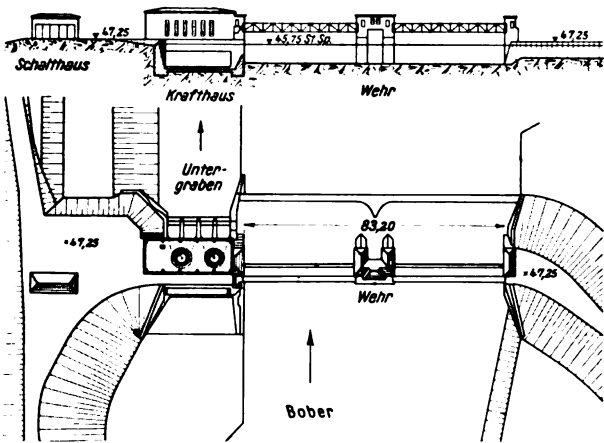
Boberkraftwerk: Wehr und Krafthaus Cressen. Lageplan und Ansicht.
